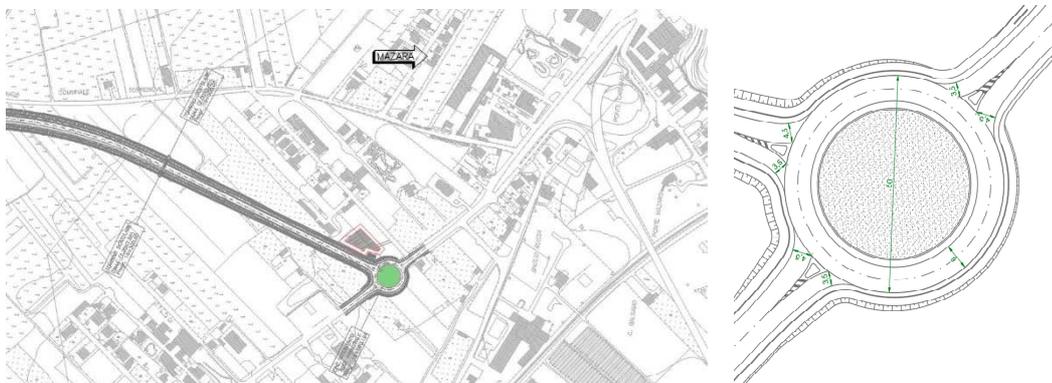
planimetria della rotatoria di fine intervento sulla S.S.115
